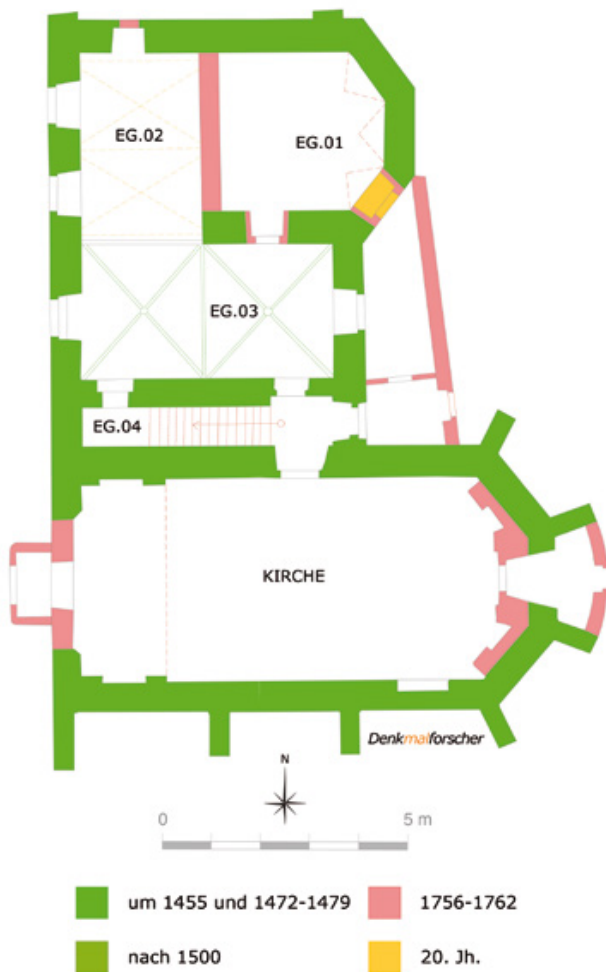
Baumgarten, Ödes Kloster. Baualterplan des Erdgeschoßes.
